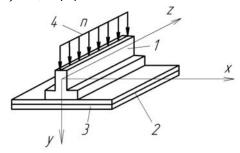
Расчетная схема модели в виде слоистой плиты: 1 — ленточный фундамент; 2 — слой геоимплантат; 3 — слой зоны уплотнения грунта; 4 — распределенная нагрузка на фундамент
